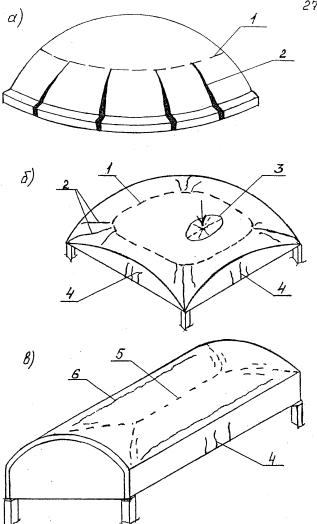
Трещины от нагрузки в железобетонных оболочках а - куполов; б -двоякой кривизны; в - цилиндрических; 1 - кольцевая трещина с внутренней стороны; 2 - меридианальные трещины; 3-трещины при местном разрушении; 4 - трещины от изгиба; 5,6 - продольные трещины с внутренней и наружной поверхности
